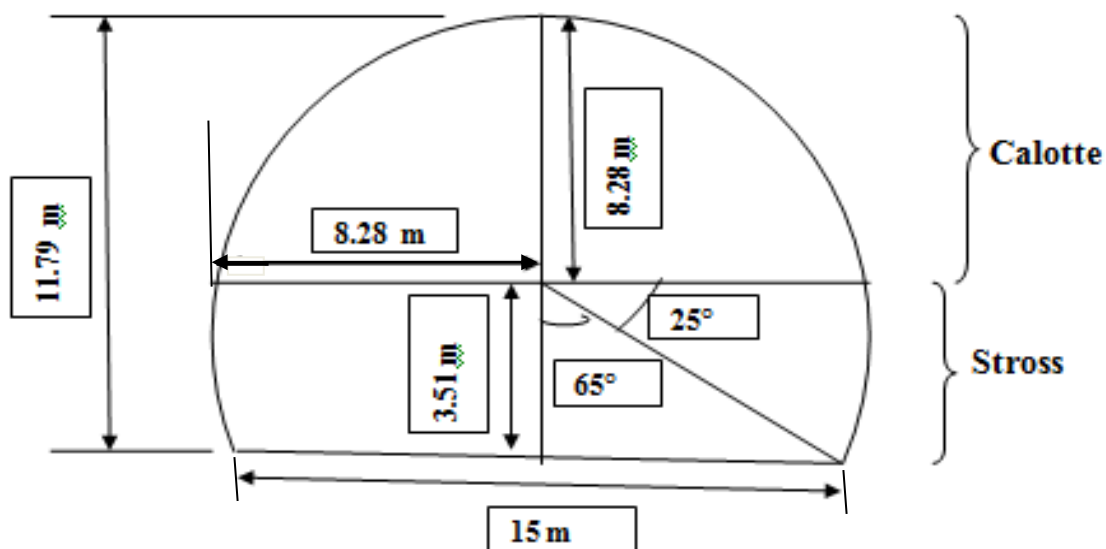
Coupe transversale du tunnel (tube droit du portail d'entrée Nord).
